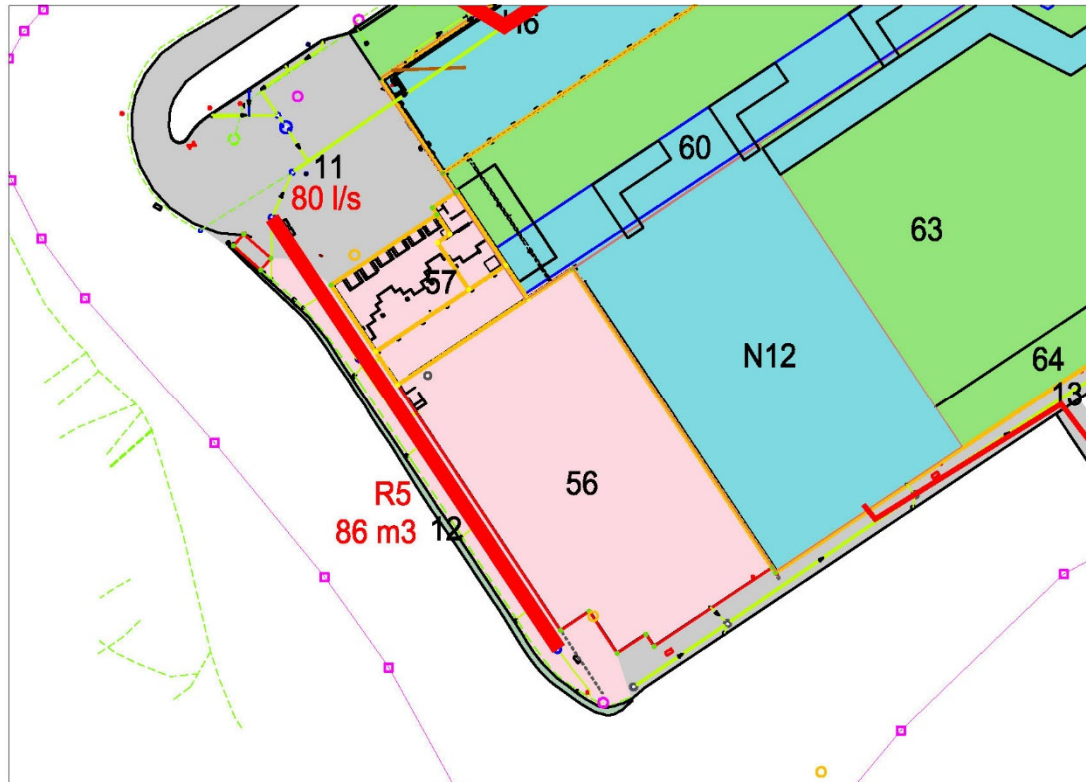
Flächenanteil für R5 – Stauraumkanal Bestand bei HRL mit Ableitung in SRK Höllgraben
